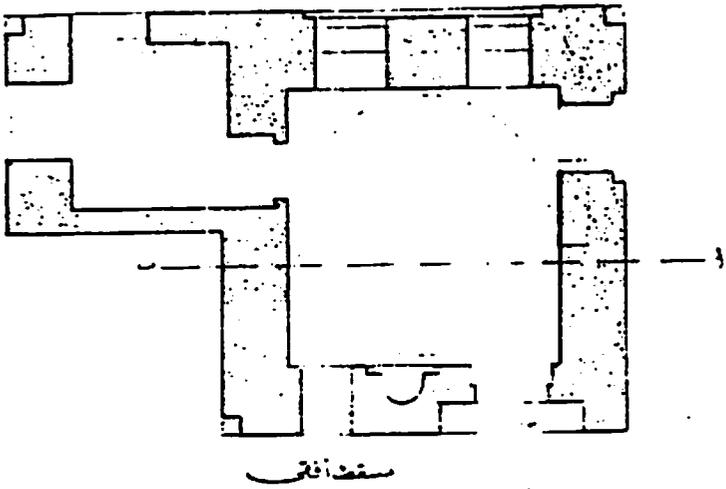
مسقط أفقي لقبة أزرمك عن هيئة الآثار
